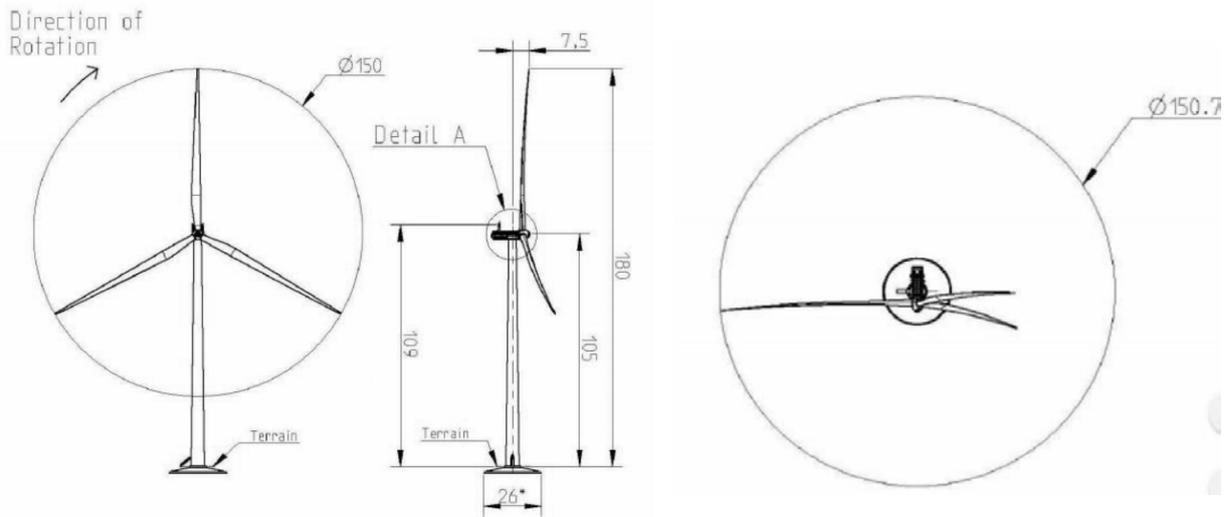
Vista prospettica, laterale e dall'alto dell'aerogeneratore VESTAS V-150 da 5,6 MW in progetto.
